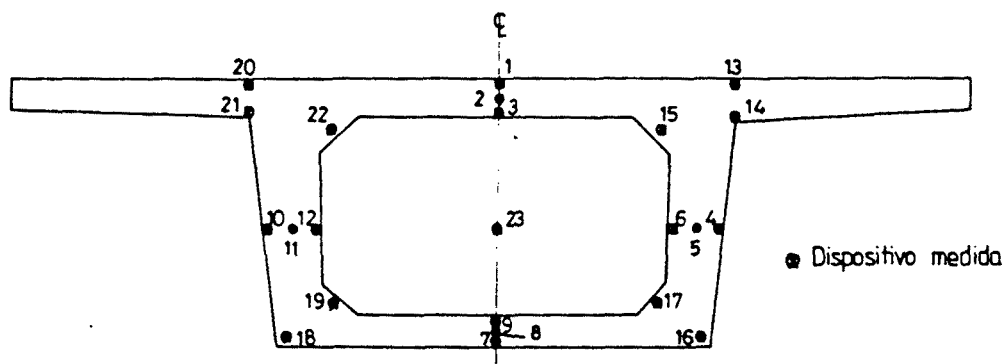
Instrumentación de puente de sección en cajón.
